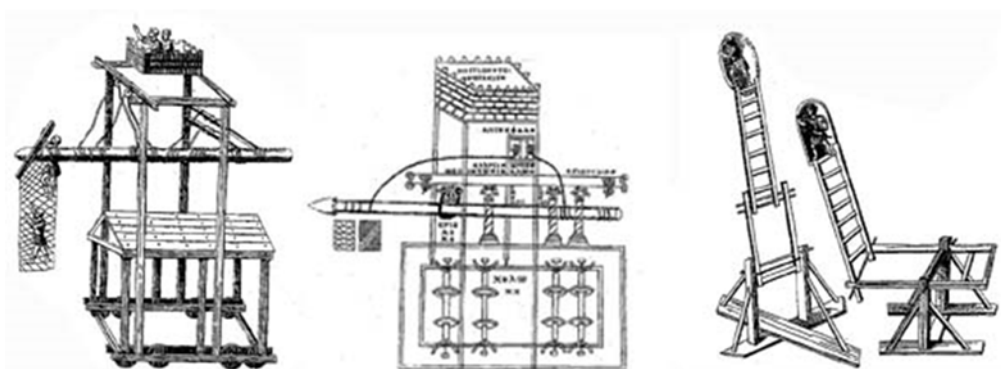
Utilaje de construcție, Libraria Vatican, Roma
